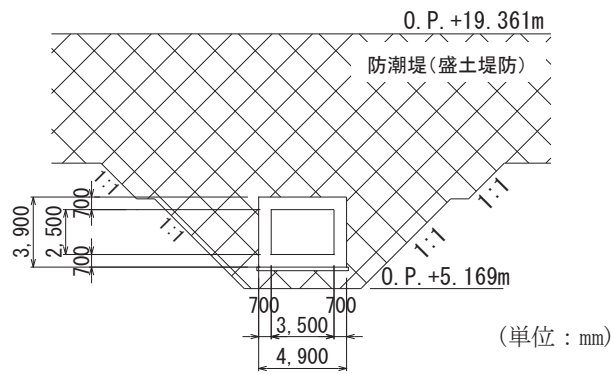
(2) 北側排水路の断面図 (B-B 断面)
